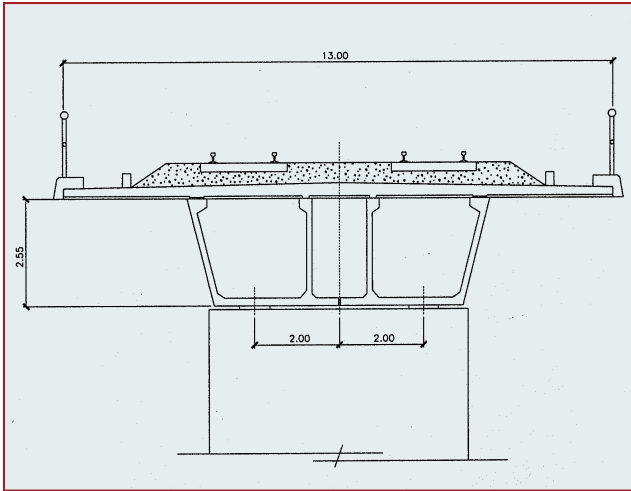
Sección transversal prefabricada propuesta como variante para el Viaducto de la Rambla en la Línea Madrid-Alicante.
